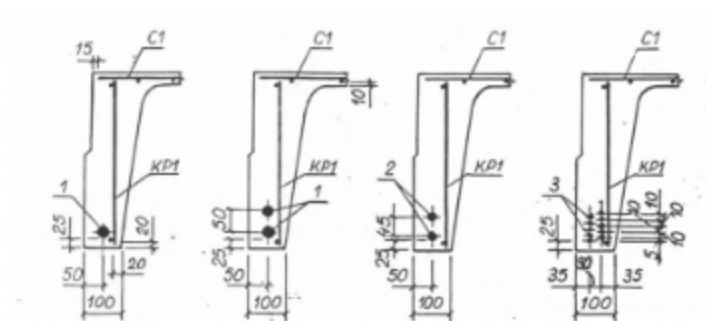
Схема розміщення напруженої арматури в поздовжніх ребрах
